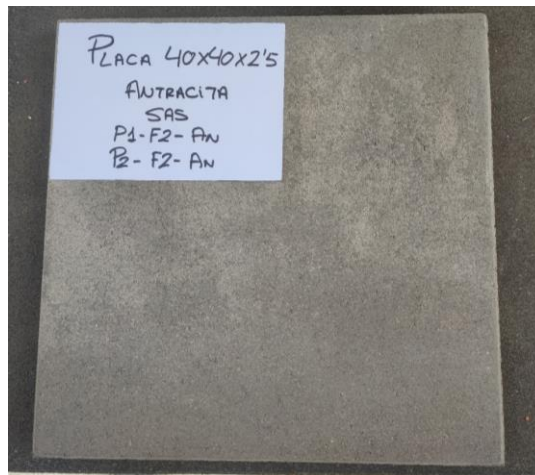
Fotografía pavimento Antracita SAS1900. Fuente: Elaboración propia.
